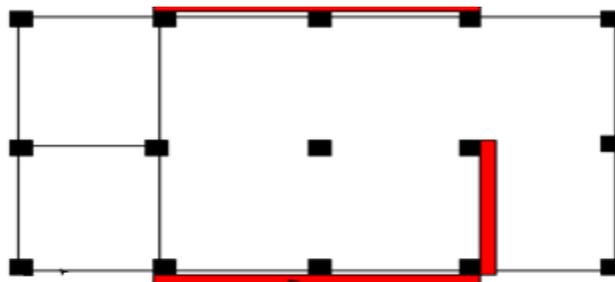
Structures « mixtes » avec des murs porteurs couplés à des portiques.
